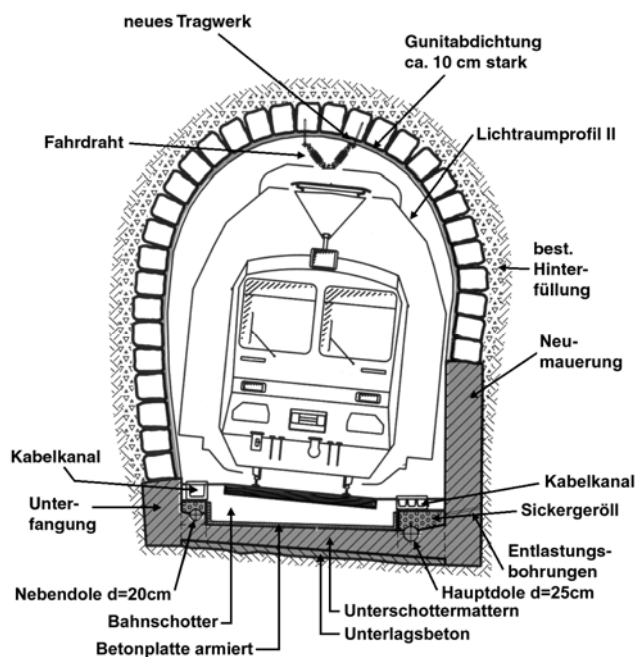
Tunnel nach Erhaltungsmassnahmen
